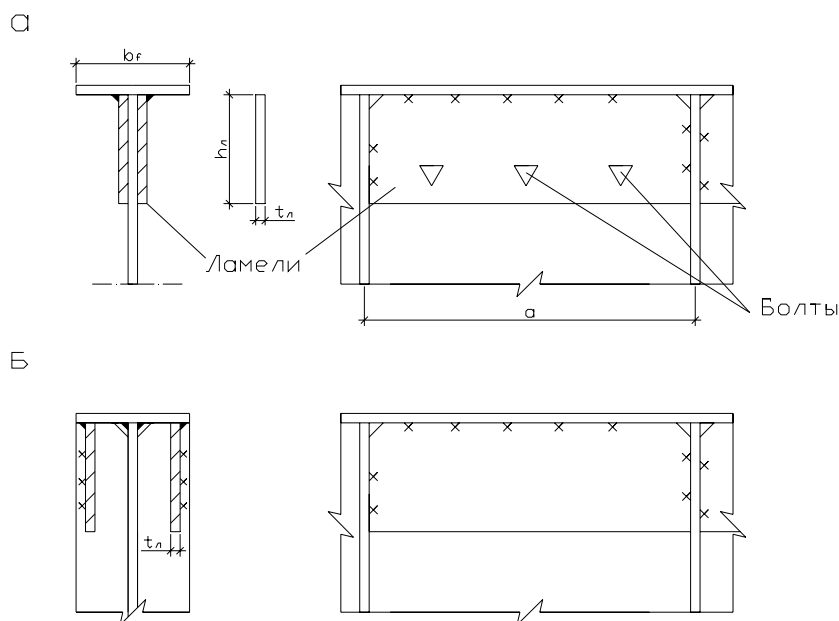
Усиление ламелями верхнего пояса подкрановой балки (варианты а и б)
